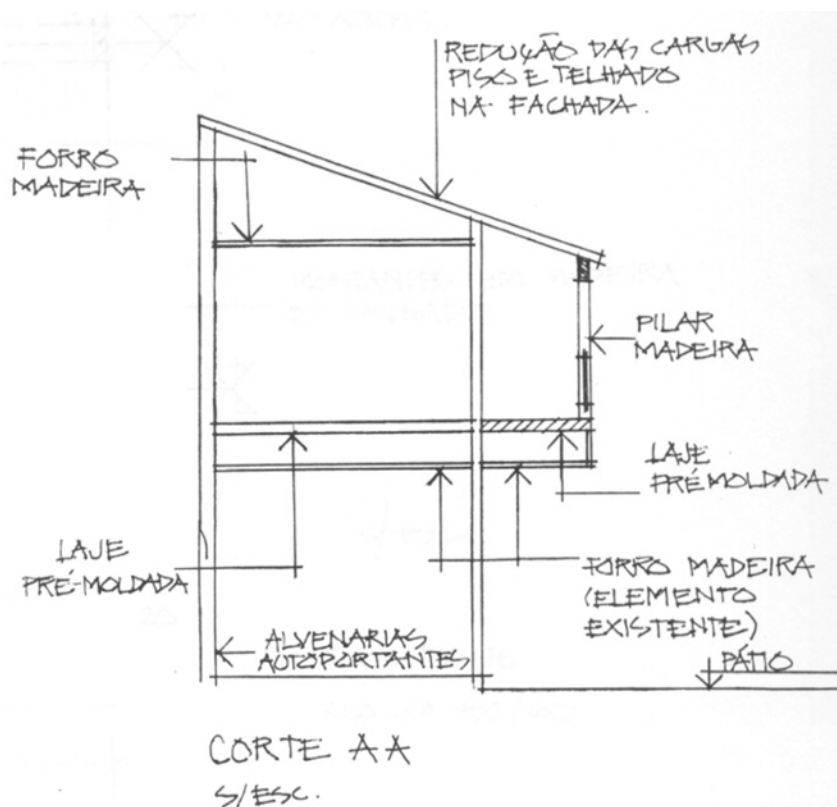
Sistema estrutural adotado (FÁBRICA, 1996, p. 8).
